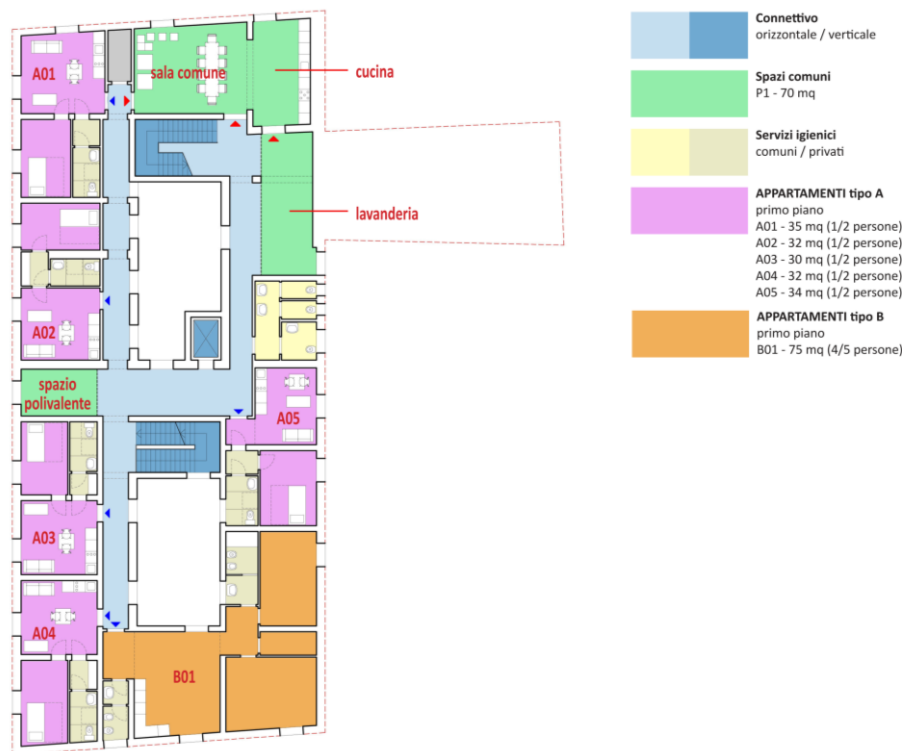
PIANTA PRIMO PIANO / STATO DI PROGETTO “CONDOMINIO SOLIDALE” (S02)
